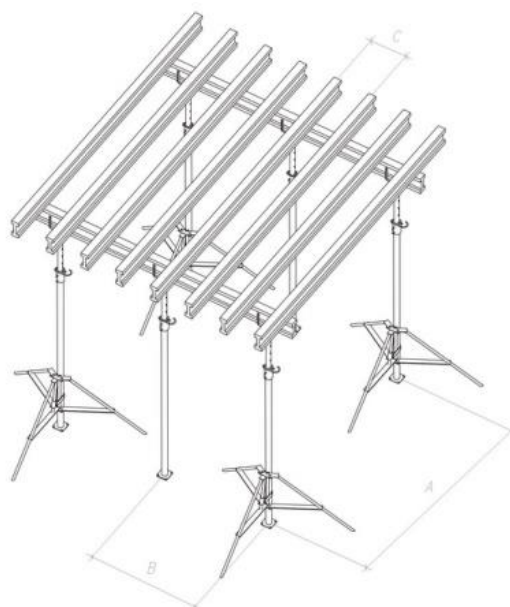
Схема расстановки телескопических стоек и раскладки деревянных балок опалубки
